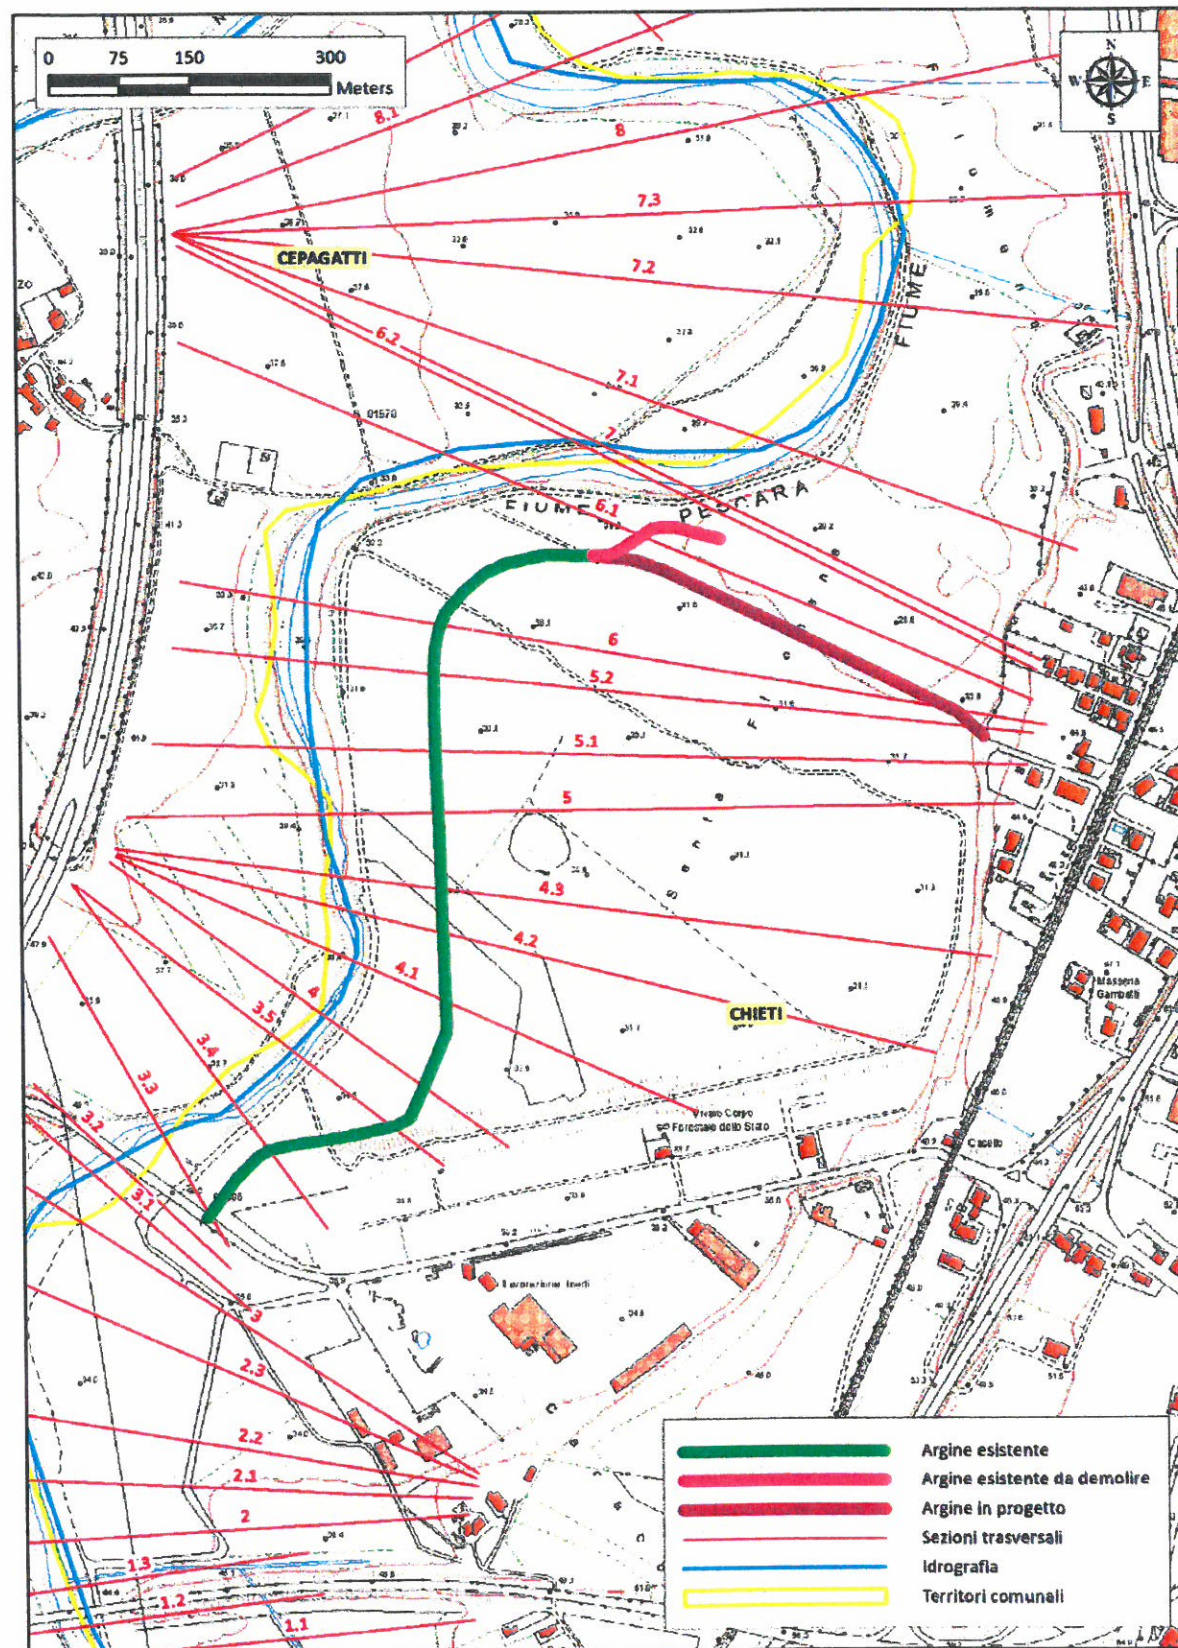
Planimetria dell'area di interesse con l'indicazione degli interventi in progetto
